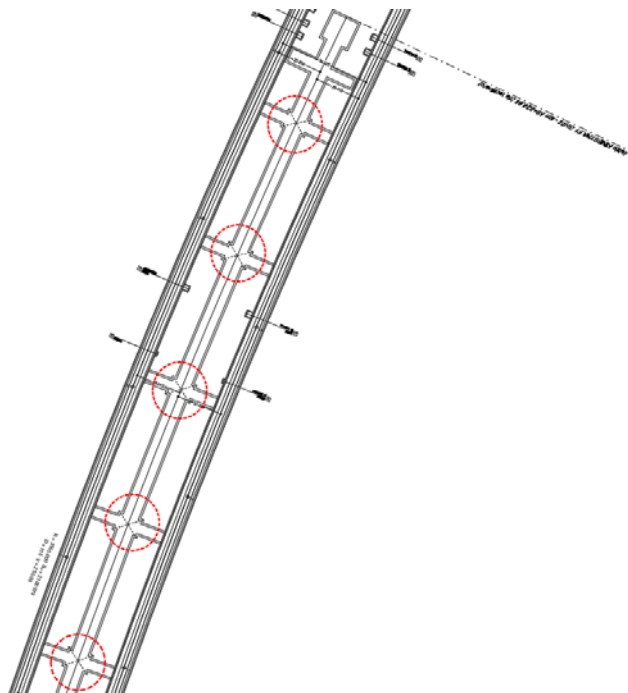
Vista planimetrica – Intersezione finestra F1 con i bypass d'esodo
